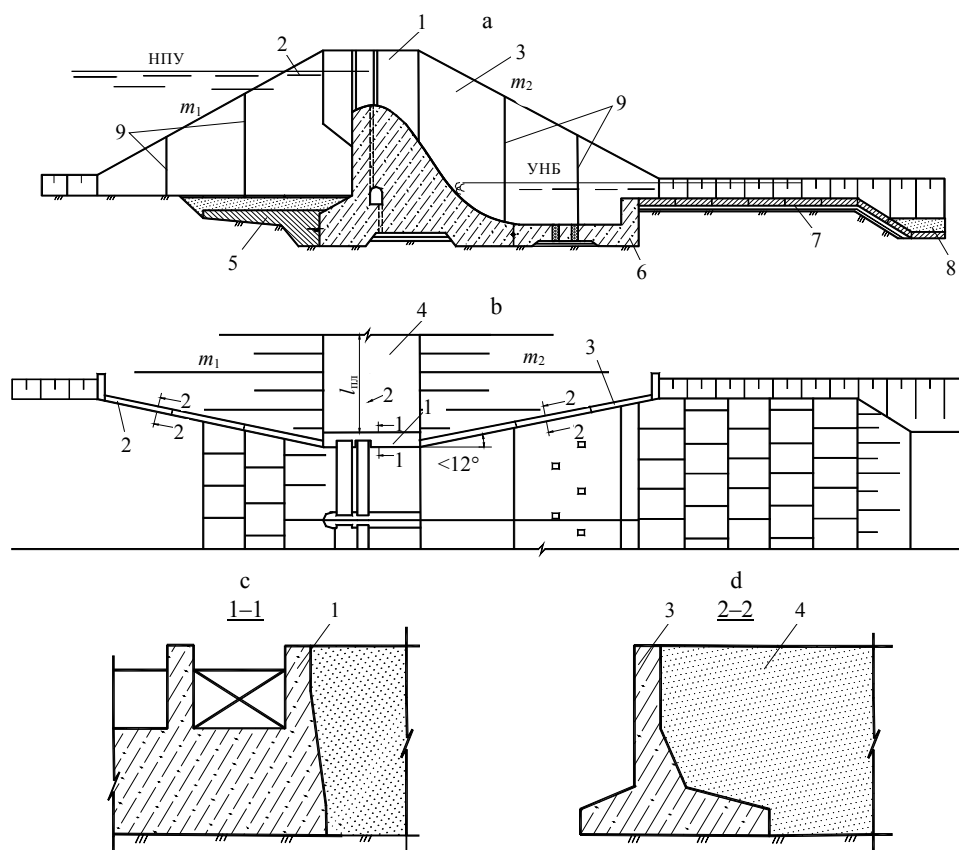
Конструкция берегового устоя: а, с, d – поперечный разрез по водосливной плотине, по вертикальной продольной стенке и по сопрягающим открылкам; б – план; 1 – вертикальная продольная стенка; 2, 3 – верхней и нижней сопрягающие открылки; 4 – земляная плотина; 5 – понур; 6 – водобой; 7 – рисберма; 8 – ковш; 9 – конструктивные швы
